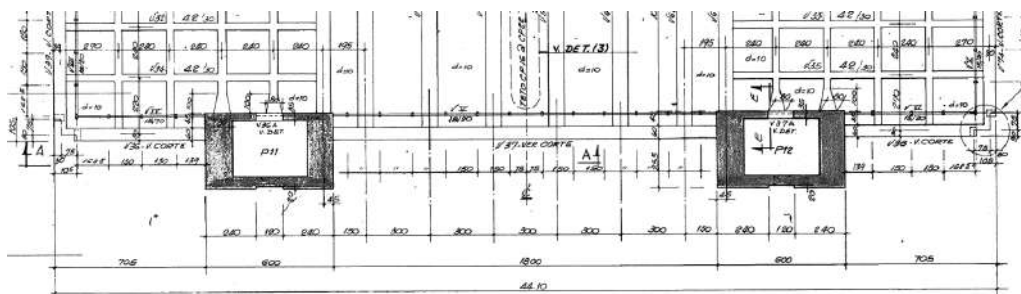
Torre Rio Sul. Ampliação da planta de Fôrmas do Teto Tipo, trecho periférico ao núcleo. Grelhas e vigas paralelas. Teto CP 01 a CP 40. Projectum Engenharia.
